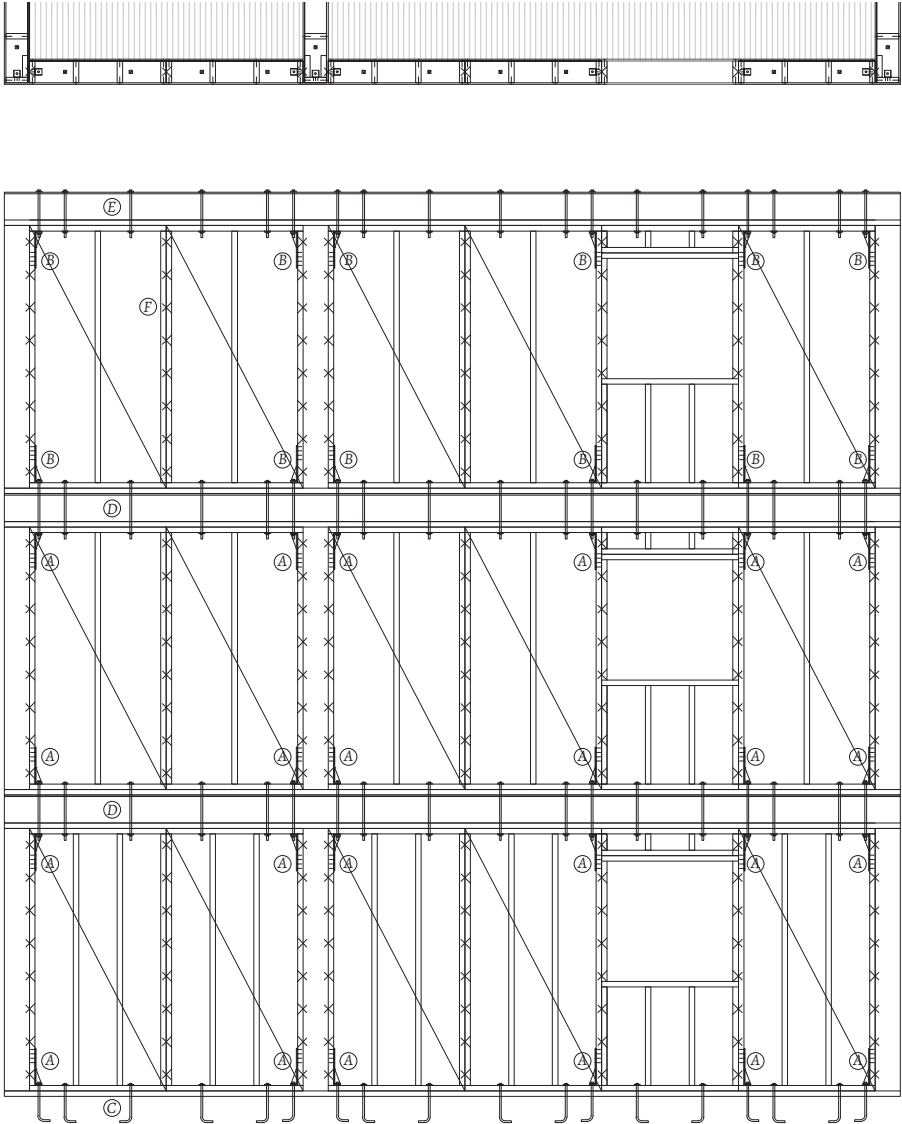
Sección y alzado con la disposición de los anclajes en el muro transversal A/A'.
